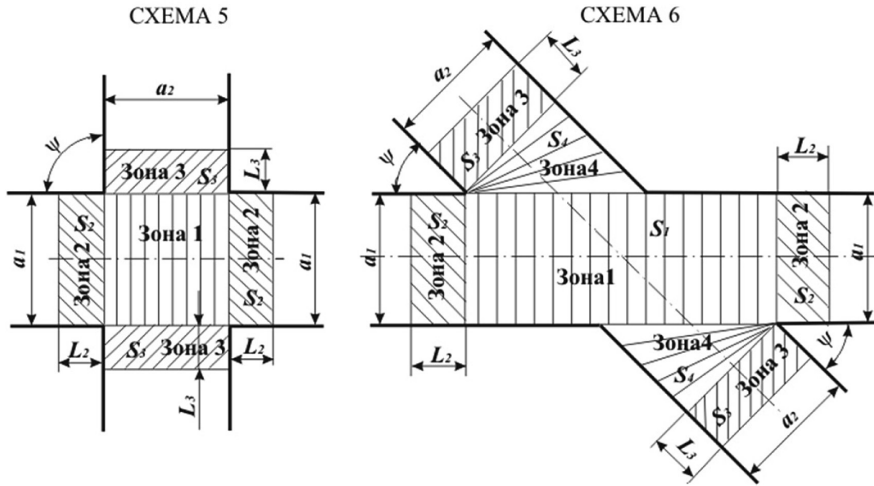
Расчетные схемы к определению площади обнажения кровли в различных зонах сопряжения выработок, пересекающихся под прямым и острым углами
